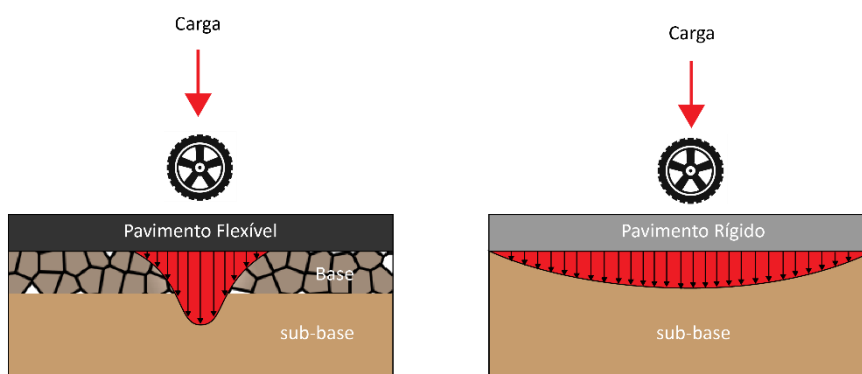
Comparação entre um pavimento flexível e um pavimento rígido (adaptado de ARAÚJO, 2016)
